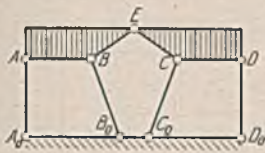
Einfaches Scheibenfachwerk mit vier Stützgliedern mit je zwei Gelenken.
